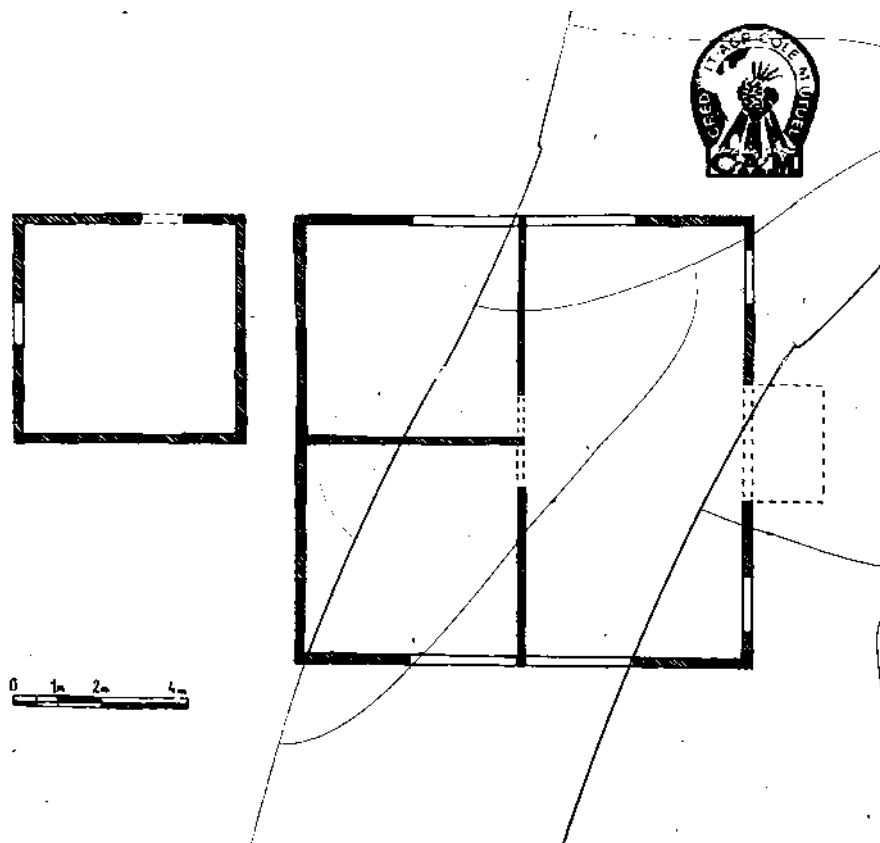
Domaine des tourelles Ausstellung, Grundriss Case Tommi (Aufnahme 22.02.2023)
